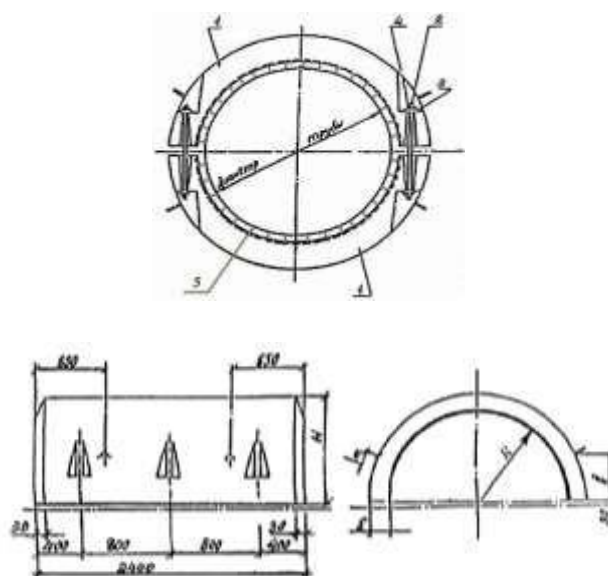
Железобетонный утяжелитель типа 2 – УТК [1]:
